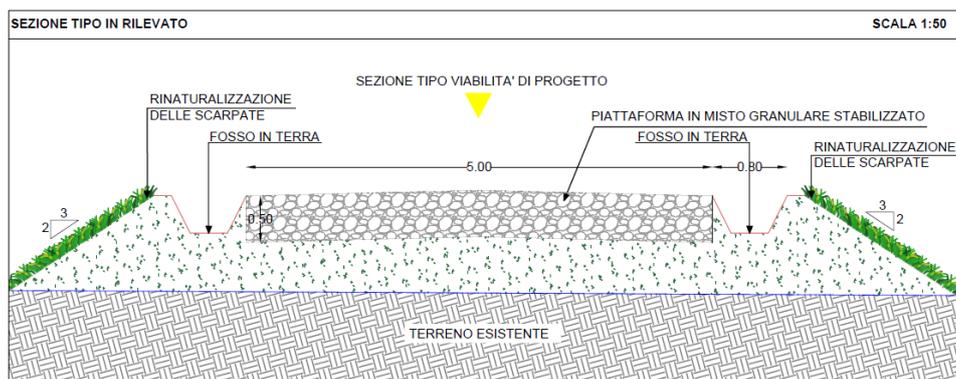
Sezione tipo in rilevato per la nuova viabilità
